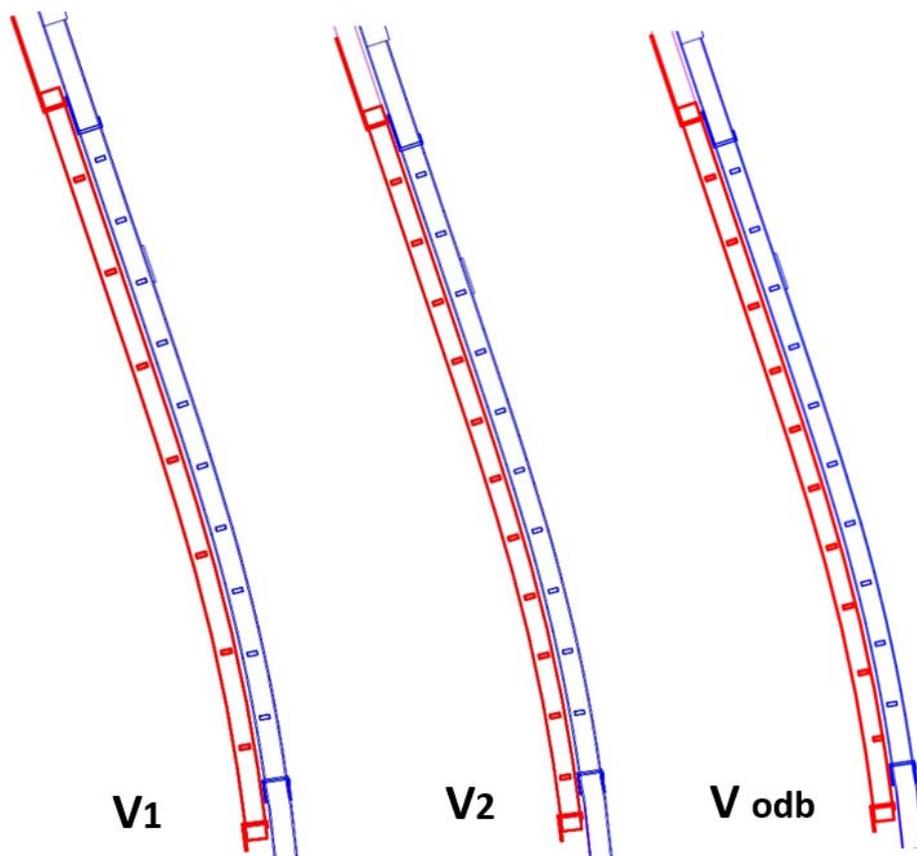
Prikaz pogleda na vijadukt Ravnišćica – varijanta 2 (plavo – postojeći, crveno – planirani)
